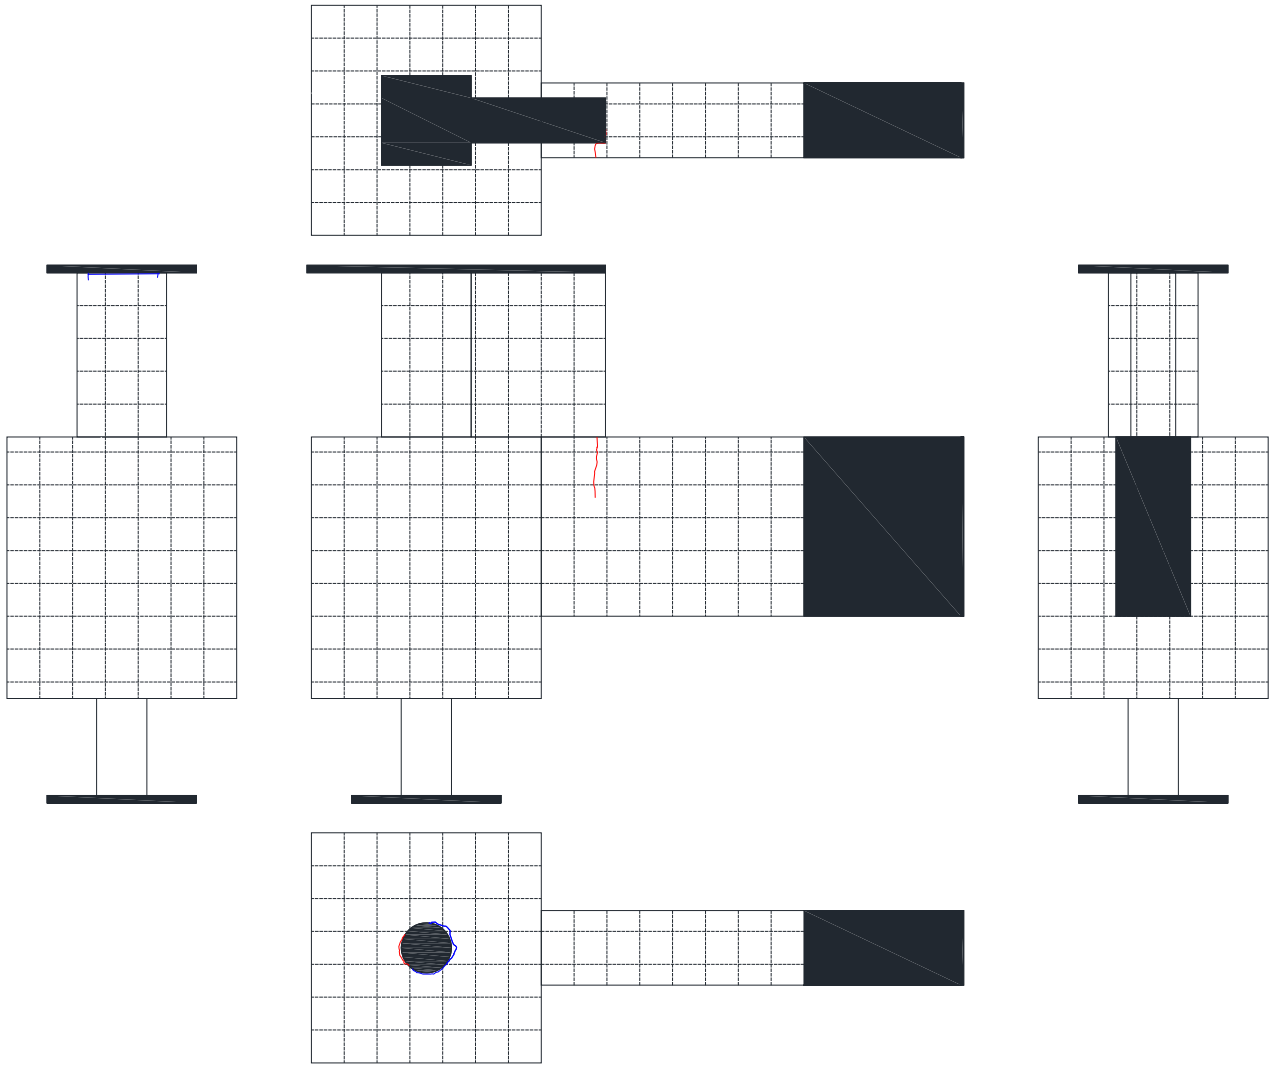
3. 4-5 ひび割れ状況 (R=±1.0%サイクル①)
